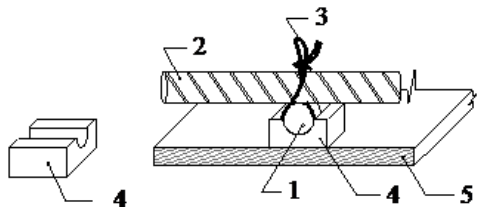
Установка фиксаторов арматуры: 1-продольной стержень; 2 – поперечный стержень; 3 – вязальная проволока; 4 – фиксатор; 5 – горизонтальная гидроизоляция
